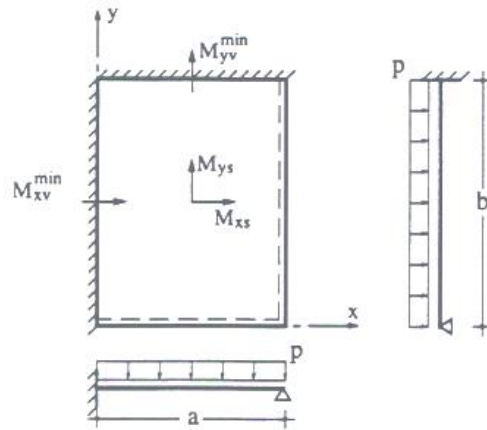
Laje apoiada-encastada, adaptado de [9]
